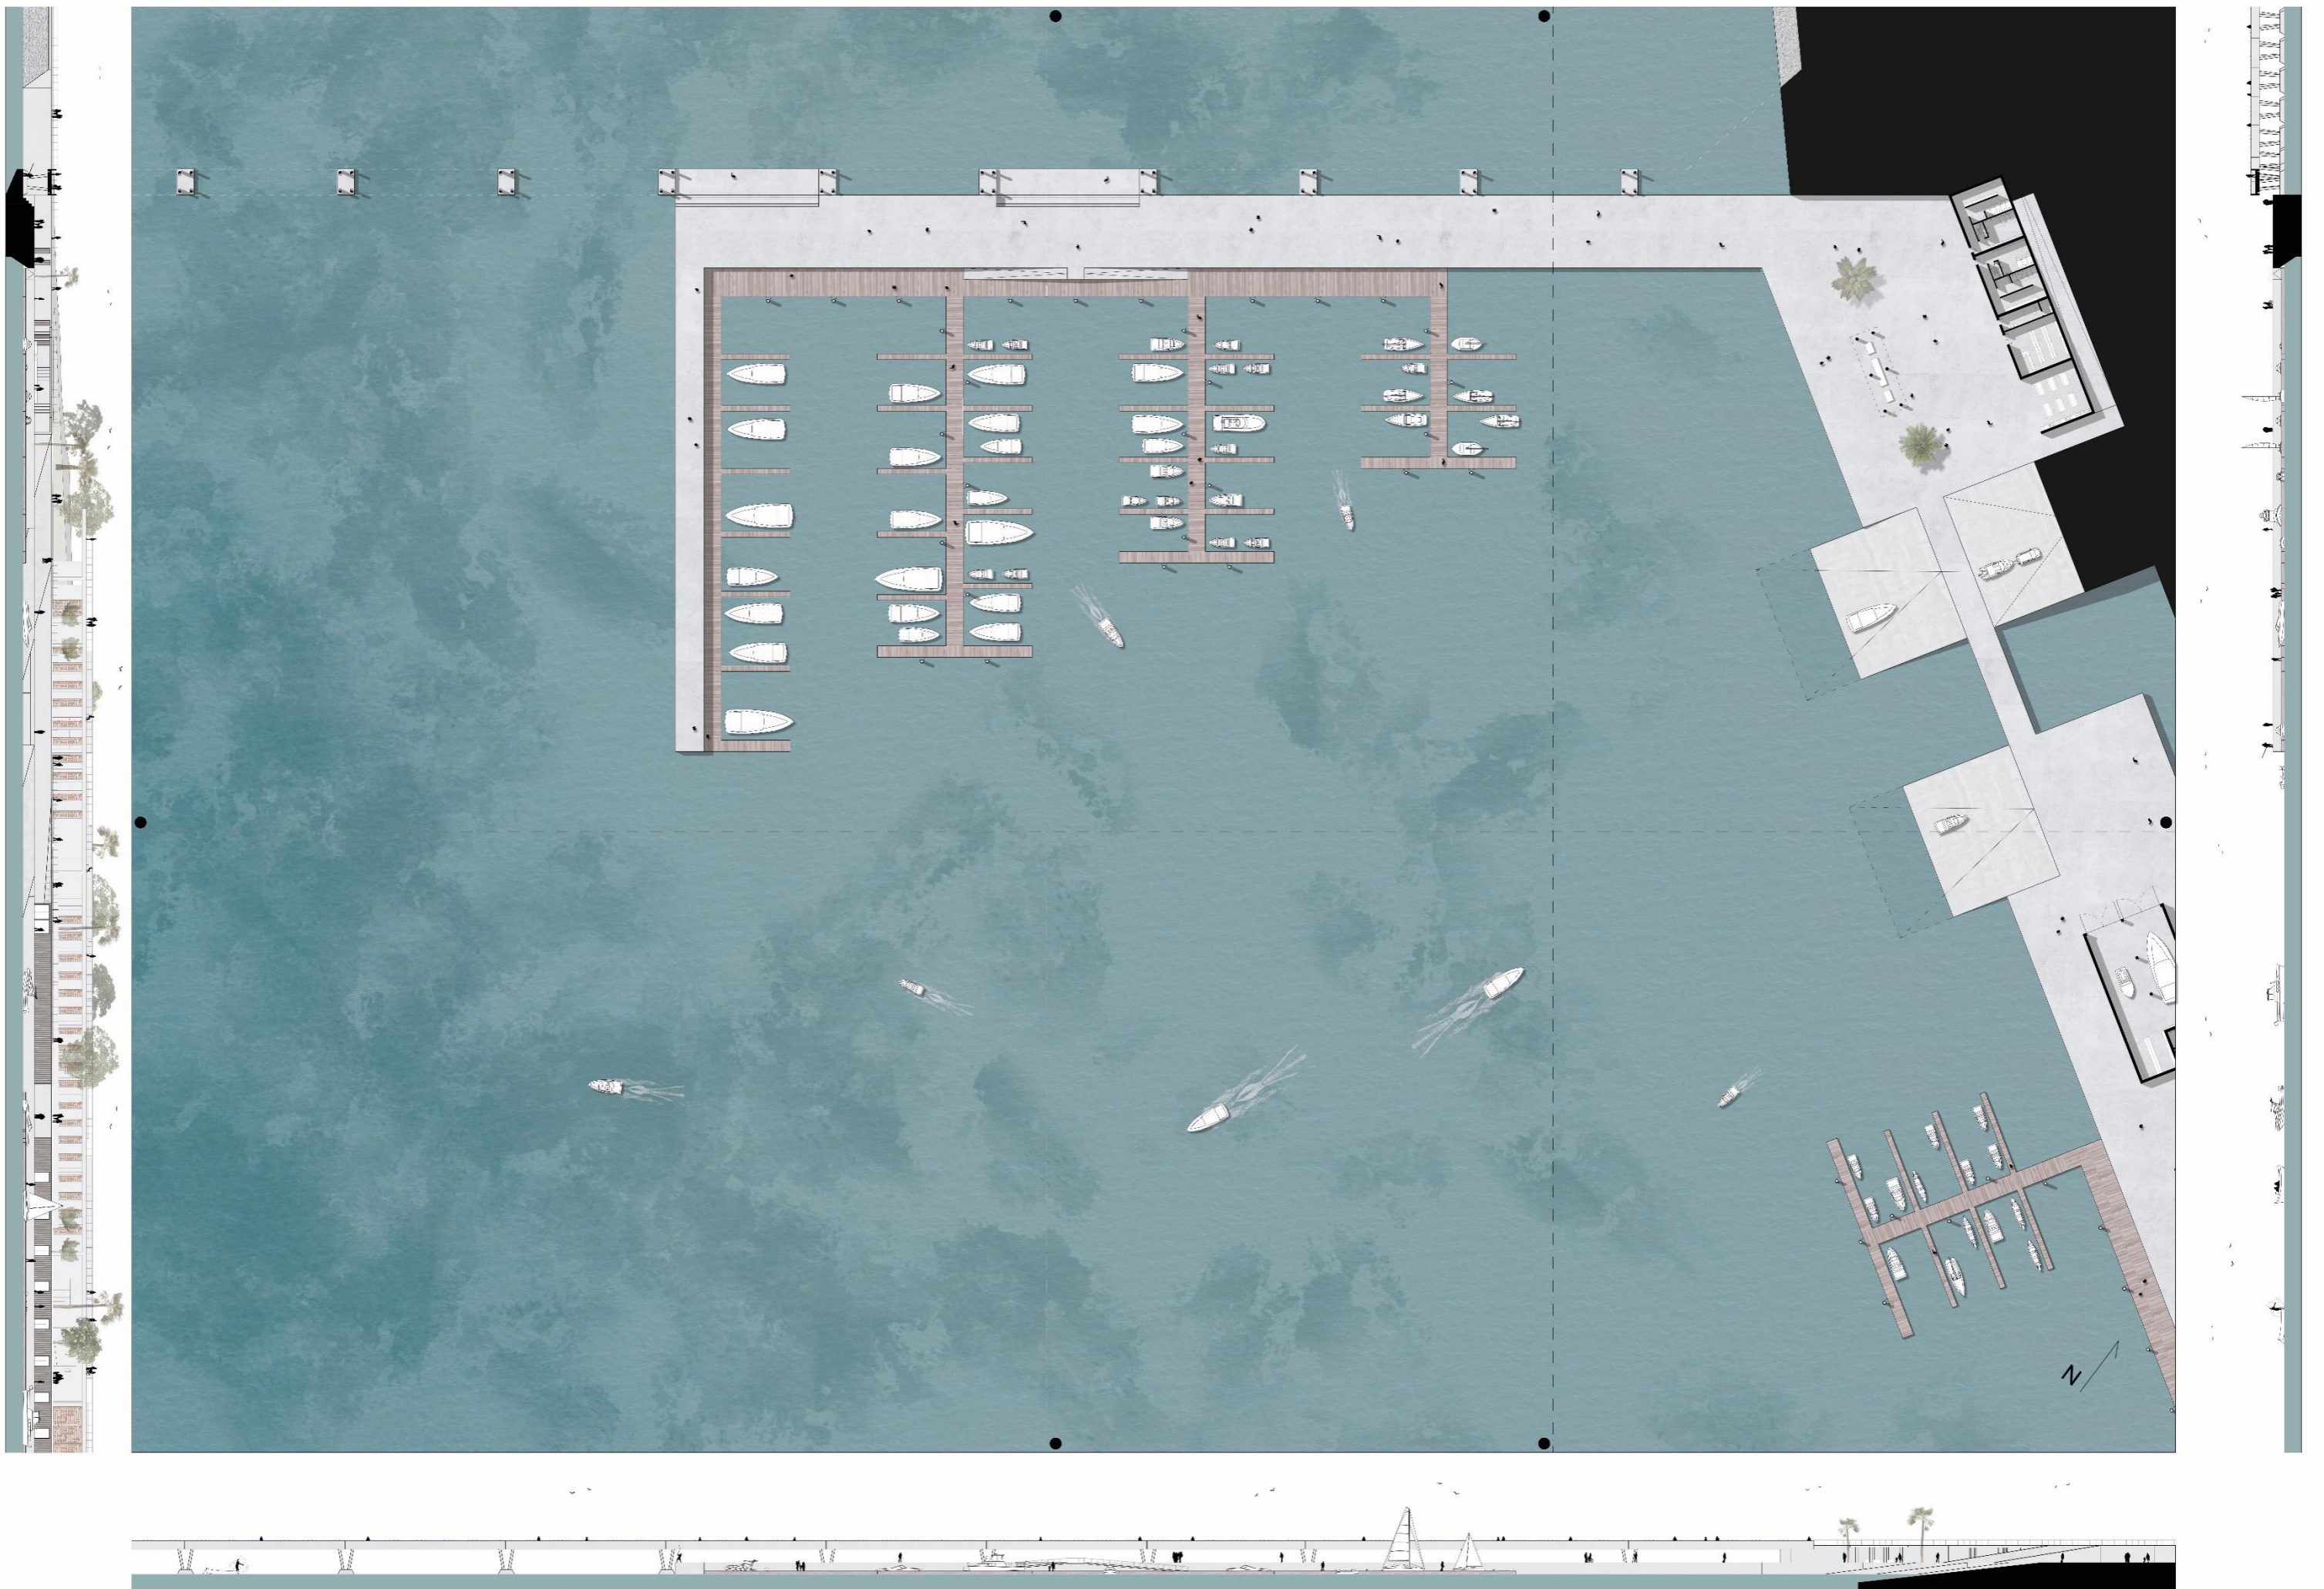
Proposta individual – Planta e Perfis do Porto de Recreio e Arranque da Ponte Pedonal (ver painel A0 nos anexos)
